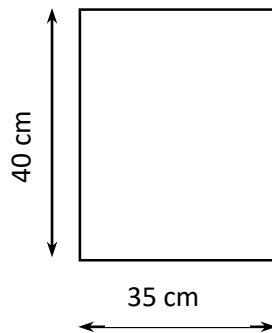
Pré-dimensionnement de la poutre palière N 02 (les escaliers d'entrée)
